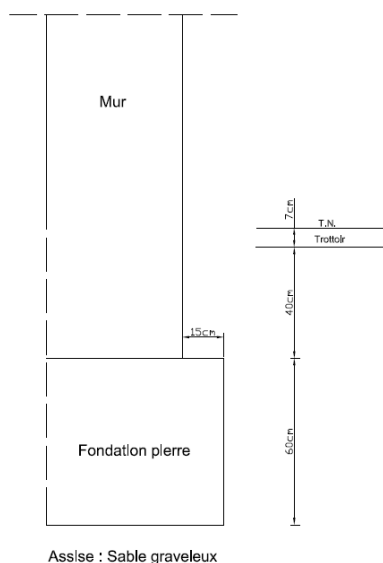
Schéma de la fondation au droit de la fouille RF2
